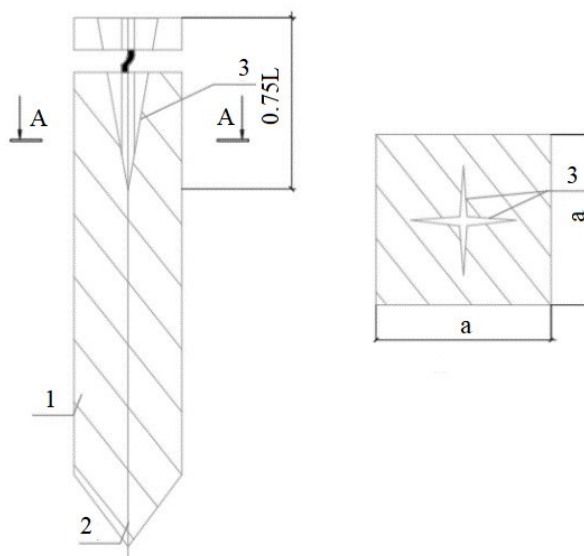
Конструкция сборной железобетонной сваи, трансформируемой в пирамидальную с помощью невзрывчатого разрушающего вещества: *1* – тело железобетонной призматической сваи; *2* – острие сваи; *3* – пластиковый клинообразный канал в виде четырехлепестковой звезды
